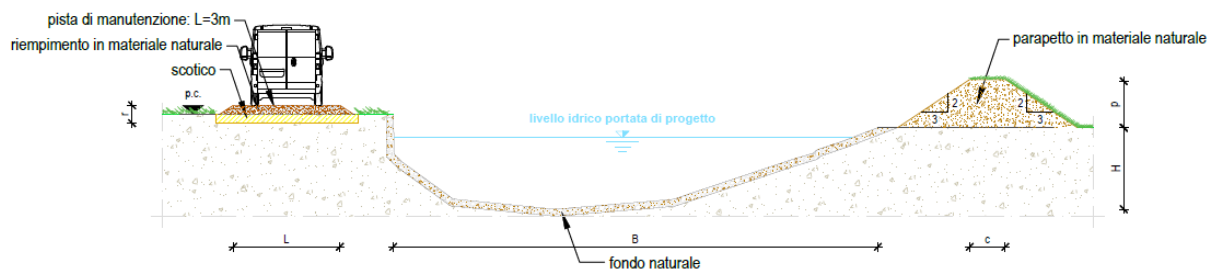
Sezione tipologica di progetto del tratto CIR-01-03 – completezza dell’intervento.
